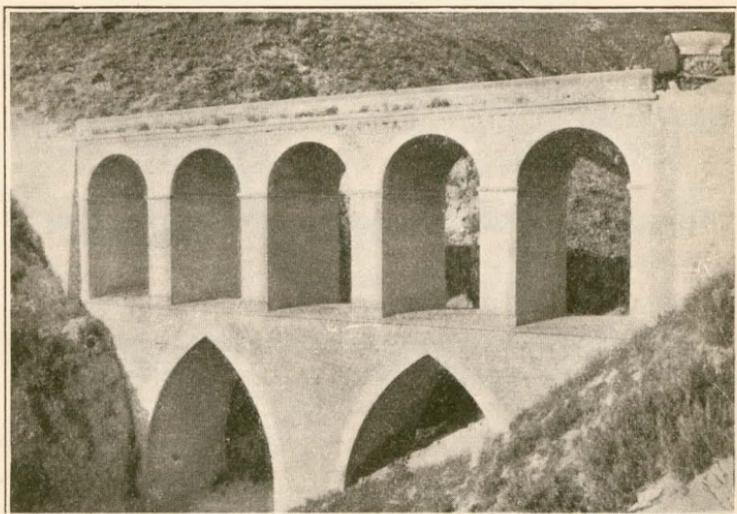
Puente sobre el Barranco de San Antonio (Alicante).
